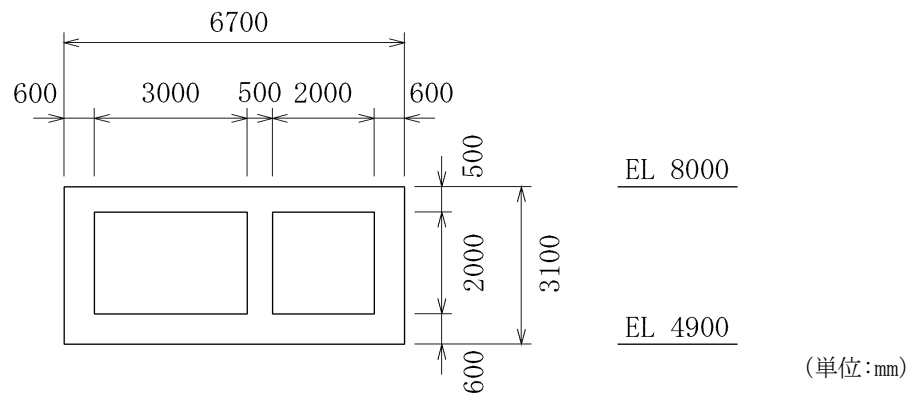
屋外配管ダクト (タービン建物～排気筒) 断面図 (A-A断面)
